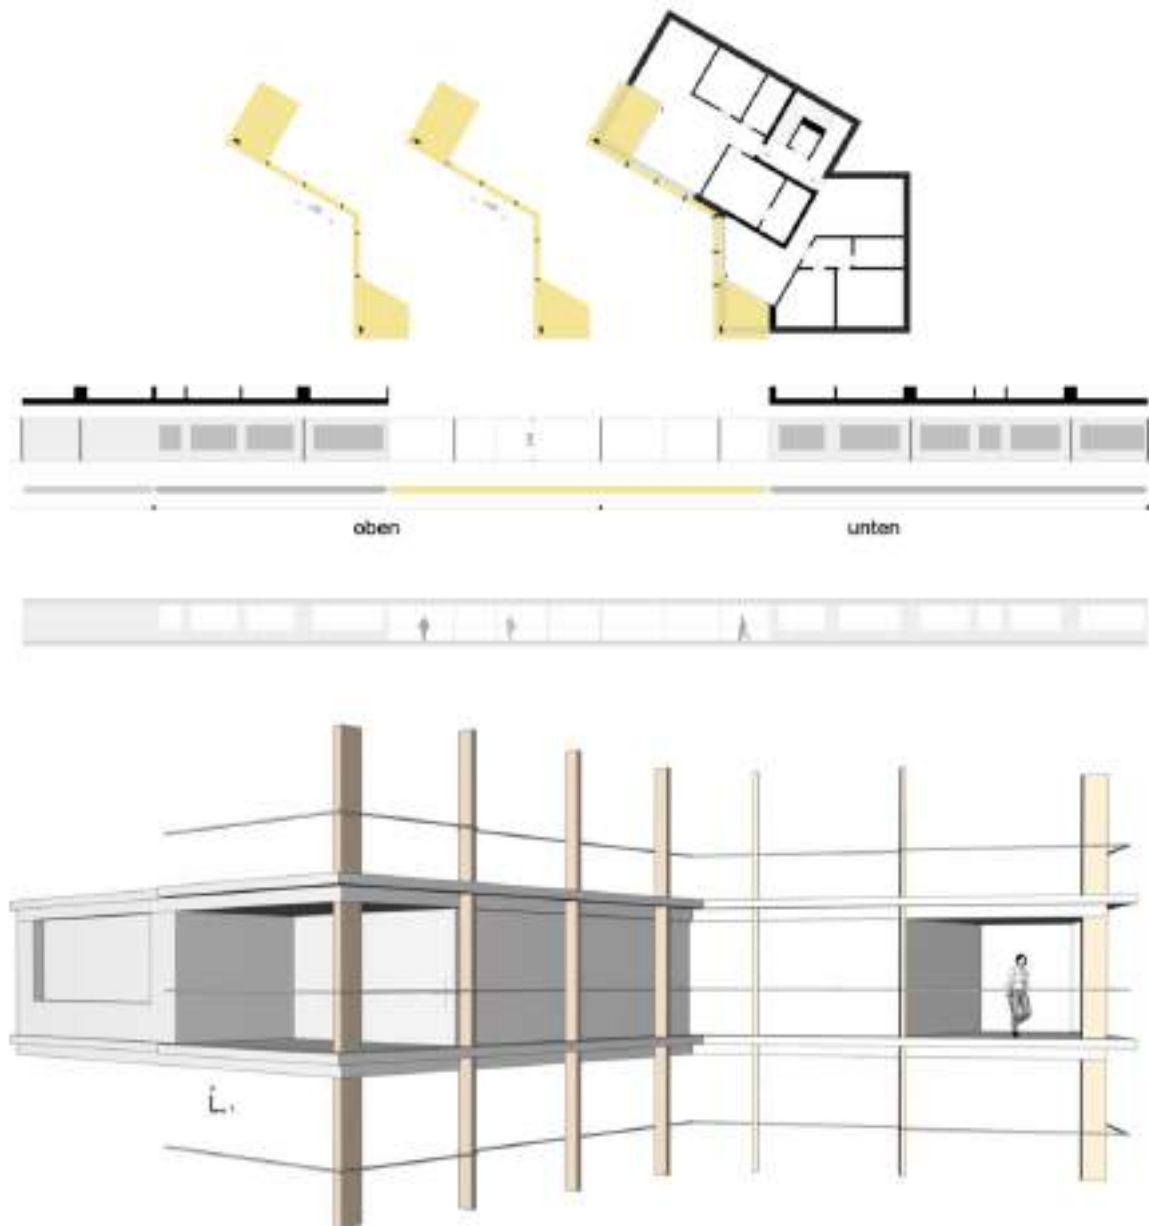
Fassadenstudien, Abwicklungen und Stossrichtungen Konstruktion
